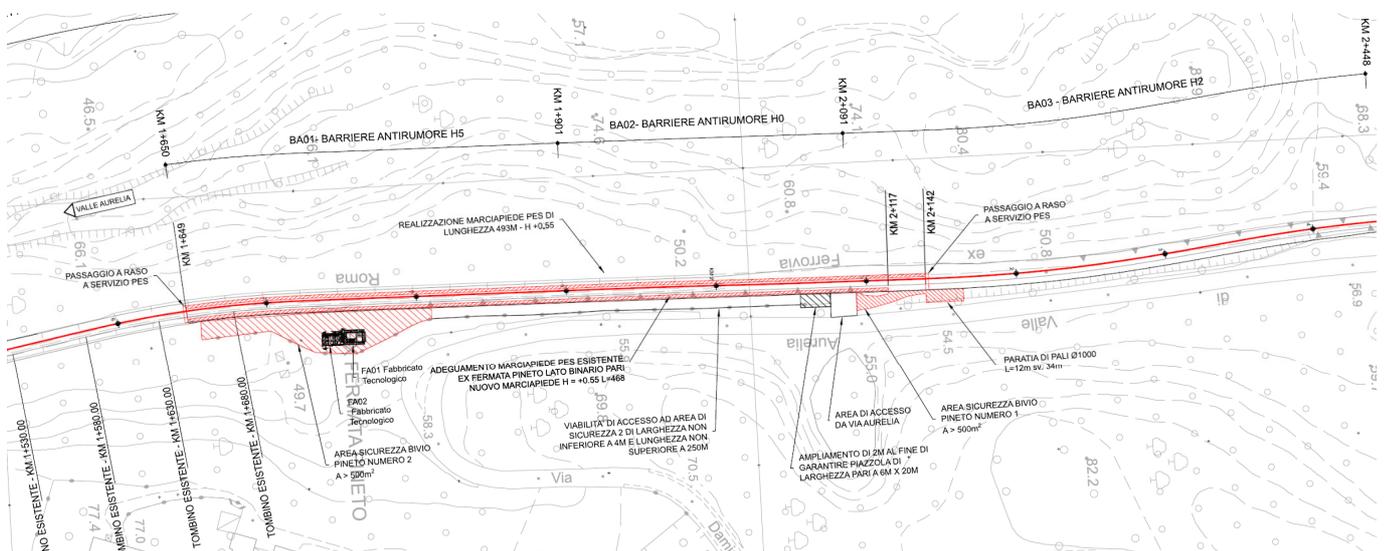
Stralcio planimetrico zona PES bivio Pineto
